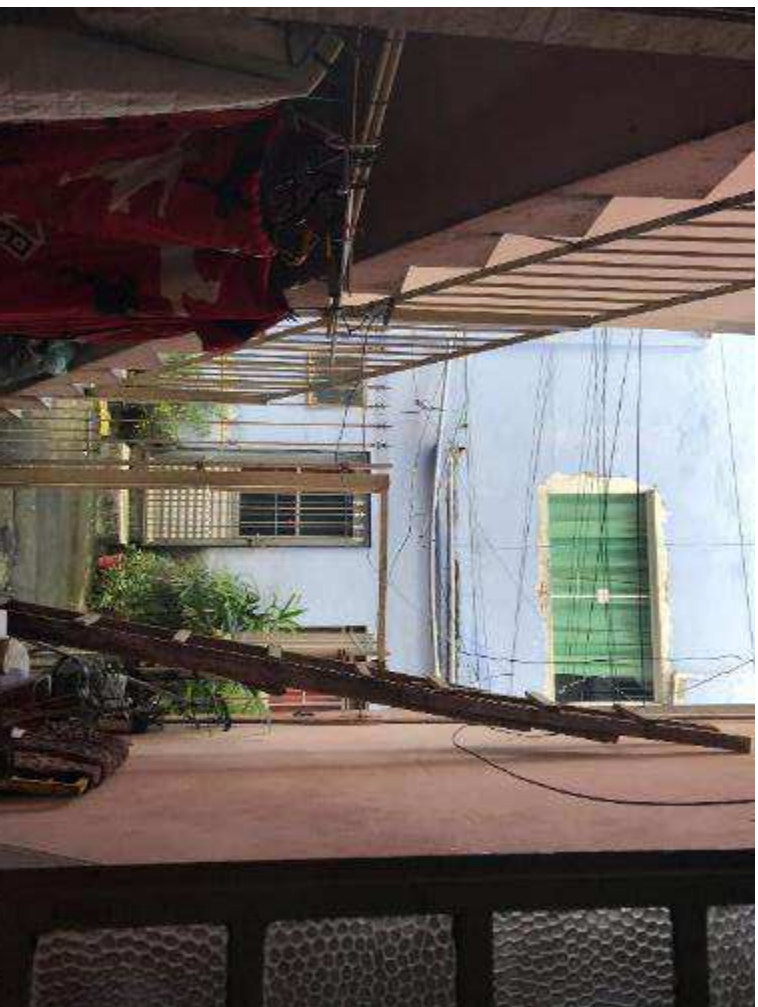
Hall de acesso à unidade habitacional térrea (Laudenice).
